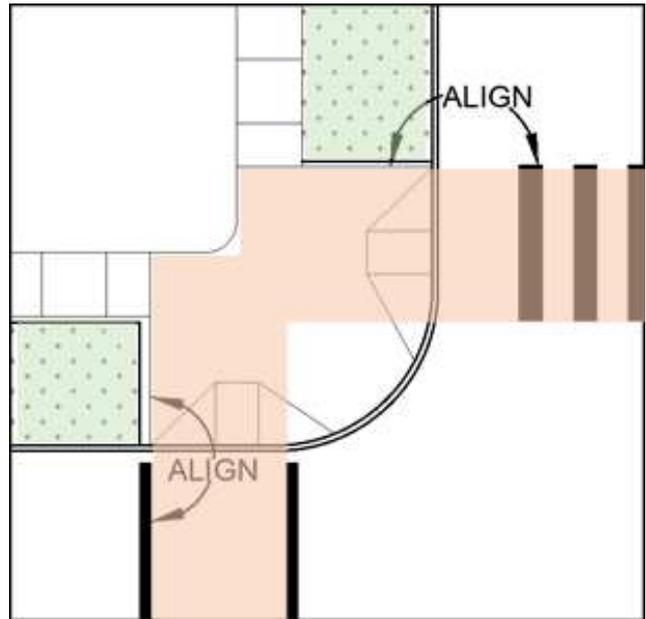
Esempio di situazione inaccettabile: le strisce pedonali portano alle strutture per le acque piovane. Fonte: Storm Water Management (SWMM)
